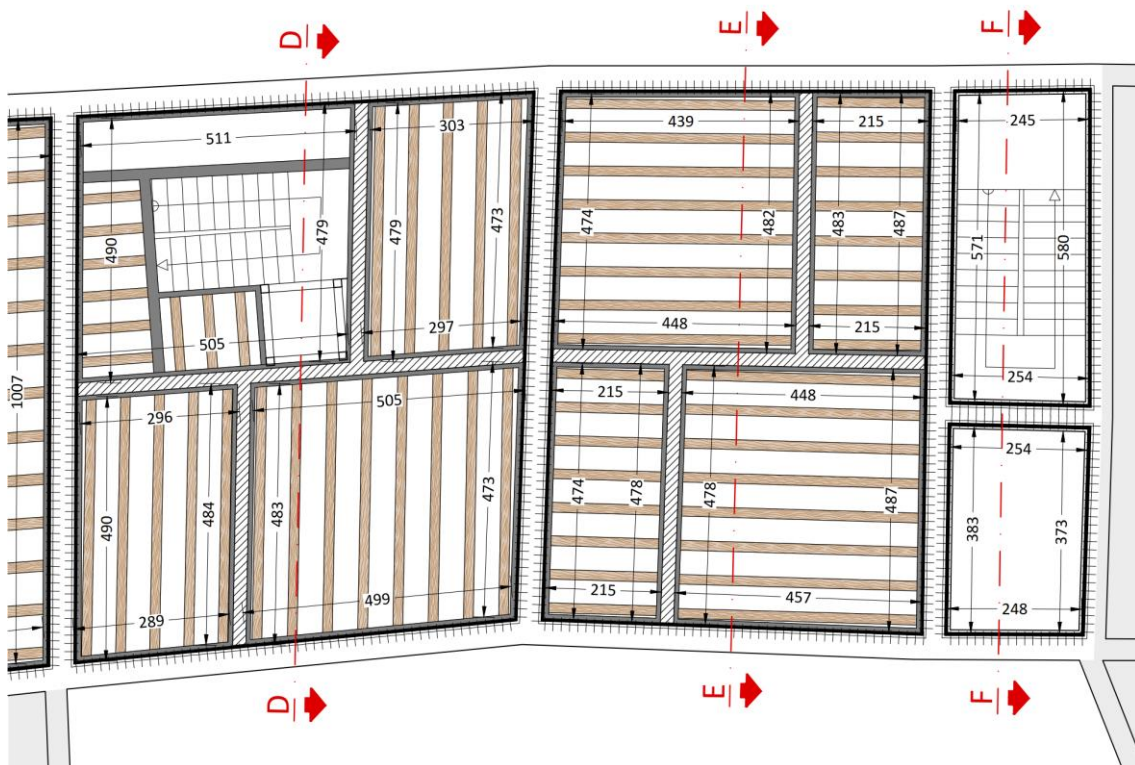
Pianta solaio piano terra dei blocchi D,E,F
